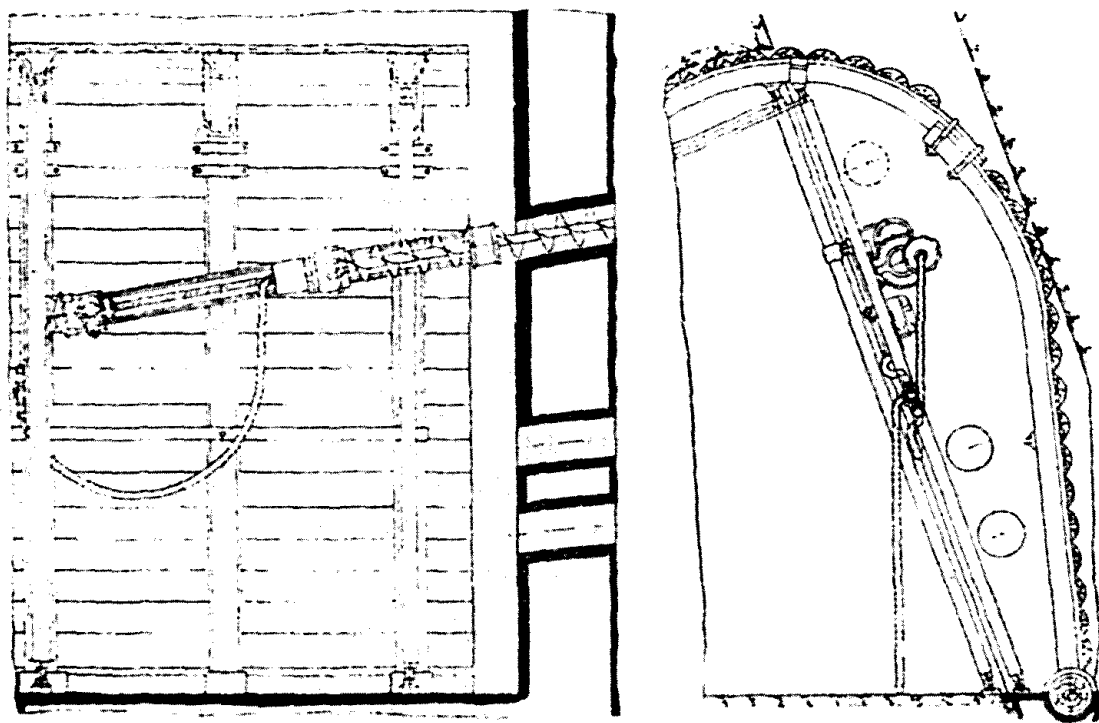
Подъемно-установочное приспособление для бурового станка.
